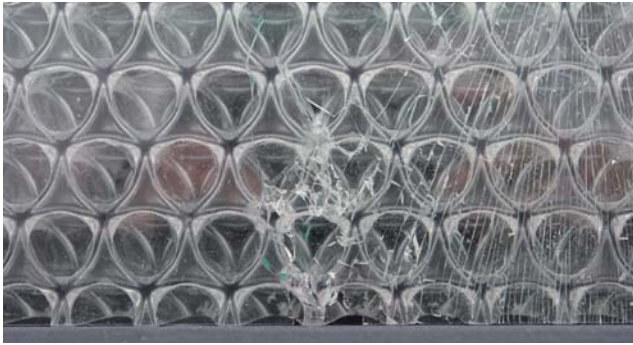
Rißbild der zugbeanspruchten Glasdeckdicht
